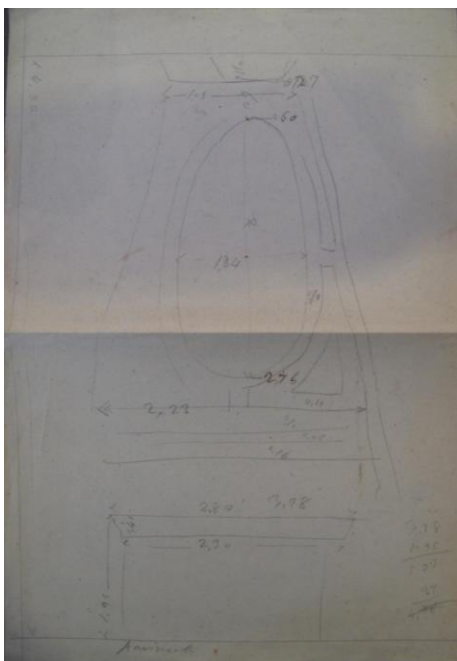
y 9.- Croquis y chimenea del salón de columnas.
